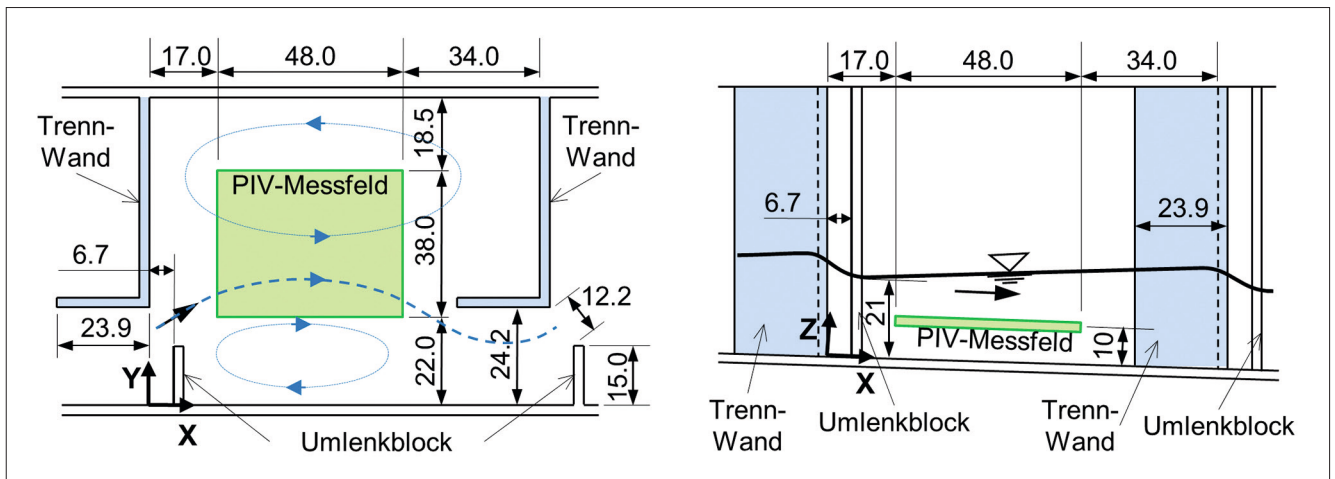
PIV-Messfeld in einem mittleren Schlitzpassbecken in der Draufsicht (links) und Seitenansicht (rechts, Abmessungen in cm)
